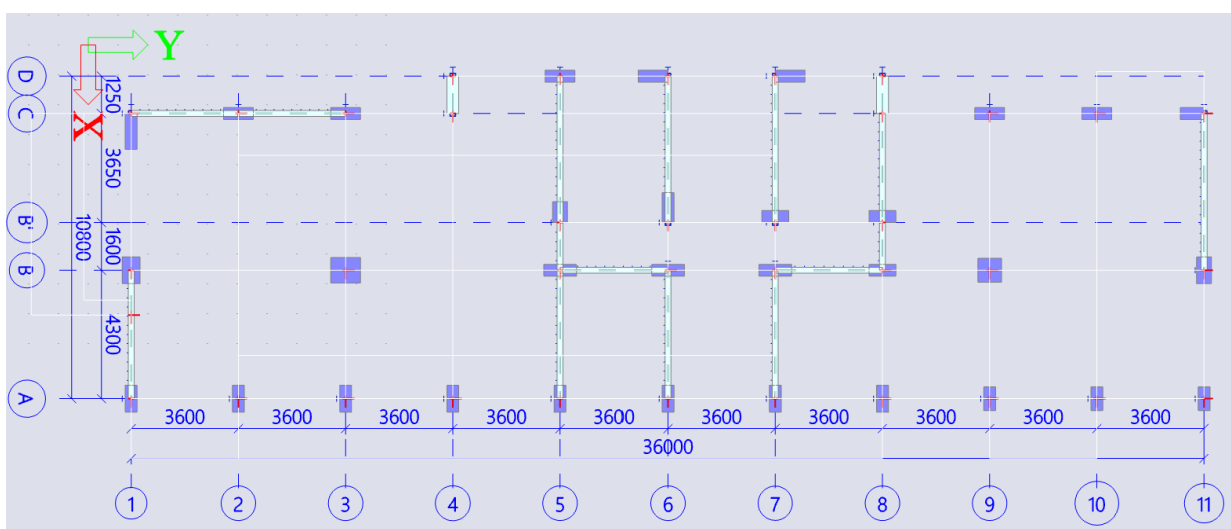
Plan parter cu elementele de rezistență verticale
